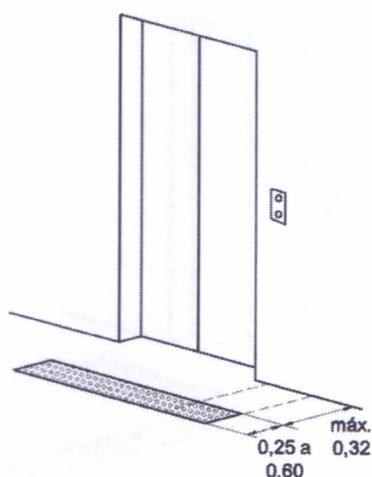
Sinalização tátil de alerta junto à porta de elevador – Exemplo
